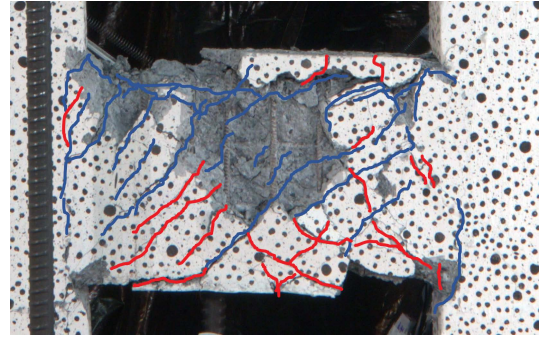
Grietas Vigas a -2% Drift
